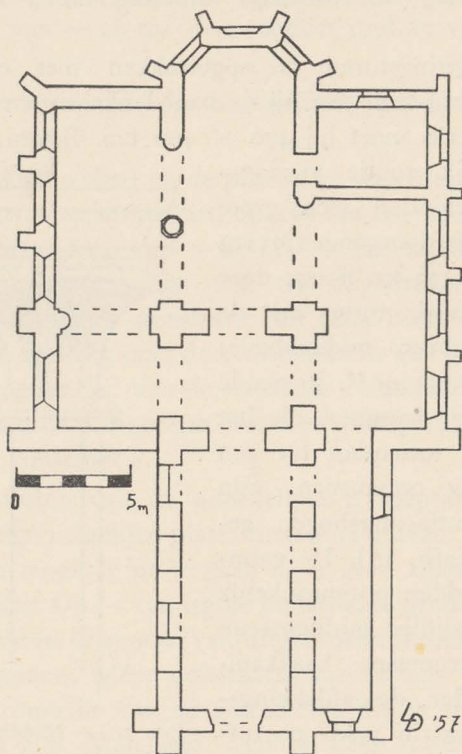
Grondplan van de kerk vóór de sloping, naar plan van E. Vandevyvere (6 sept. 1864) bewaard in de Kon. Kommissie te Brussel.
